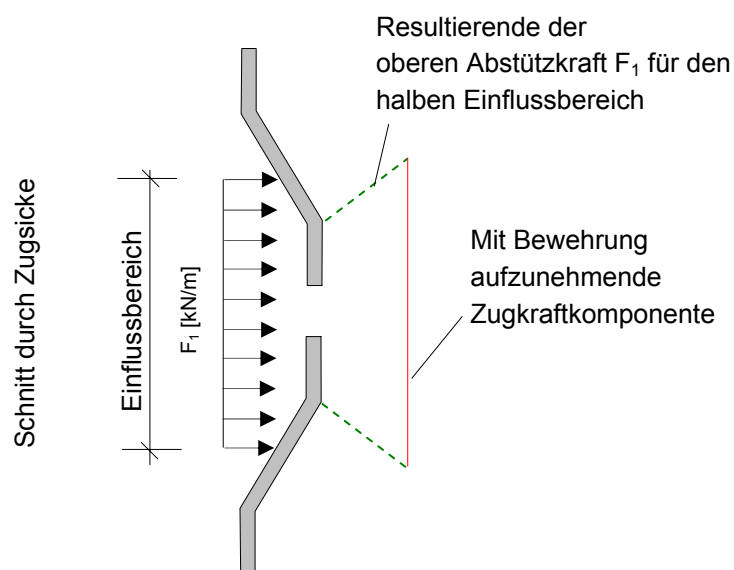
Ermittlung der horizontalen Bewehrung auf der Unterseite des Betongurts
